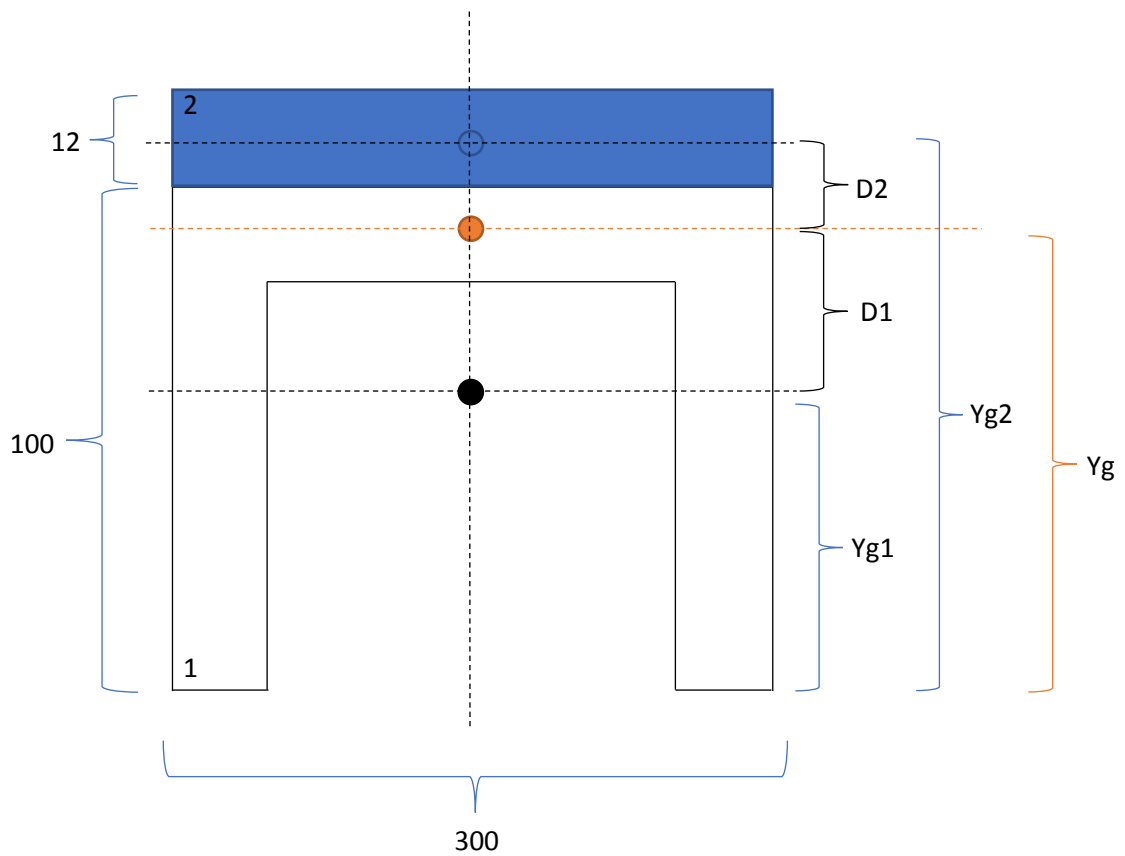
Sección del perfil inicial + chapa soldada
